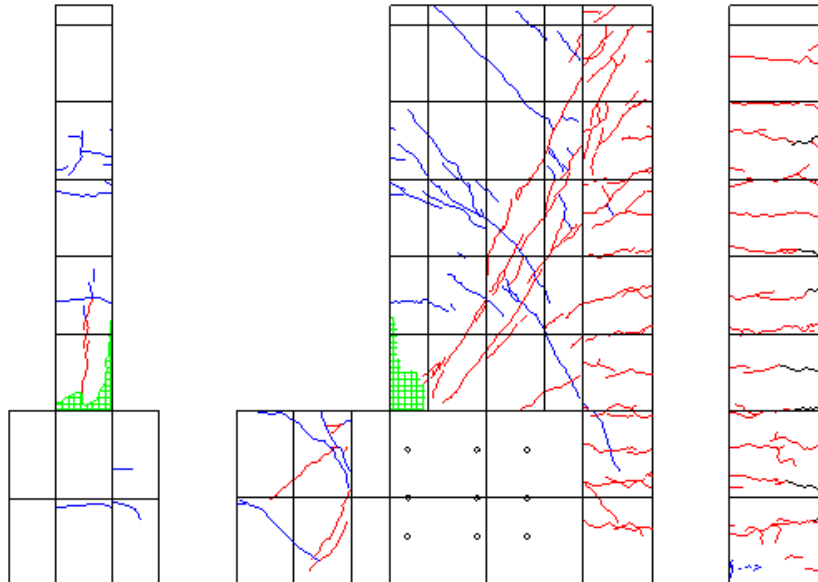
R=1/50②ひび割れ図
